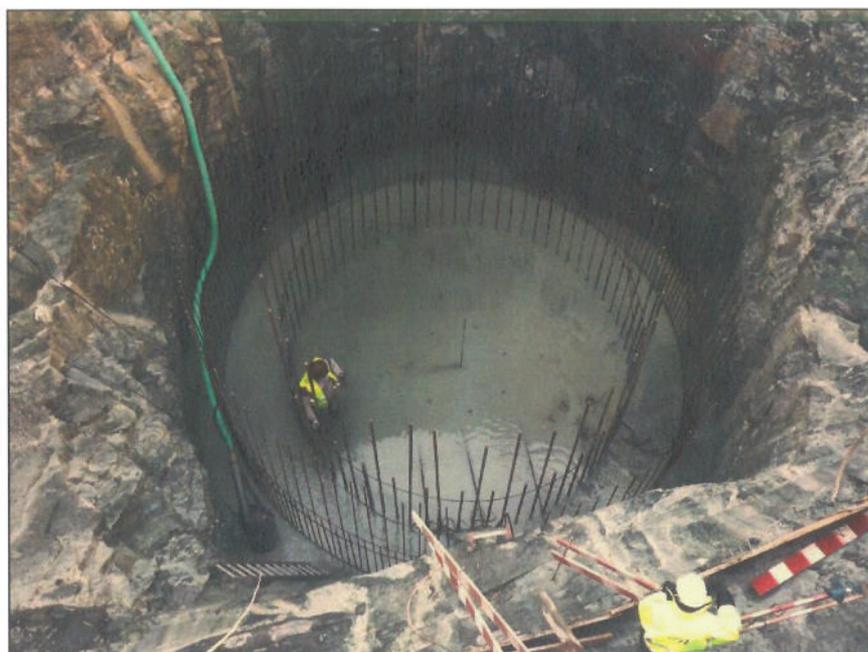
Central – Poço de bombagem – Montagem das armaduras das paredes, na sequência da betonagem da laje de fundo
